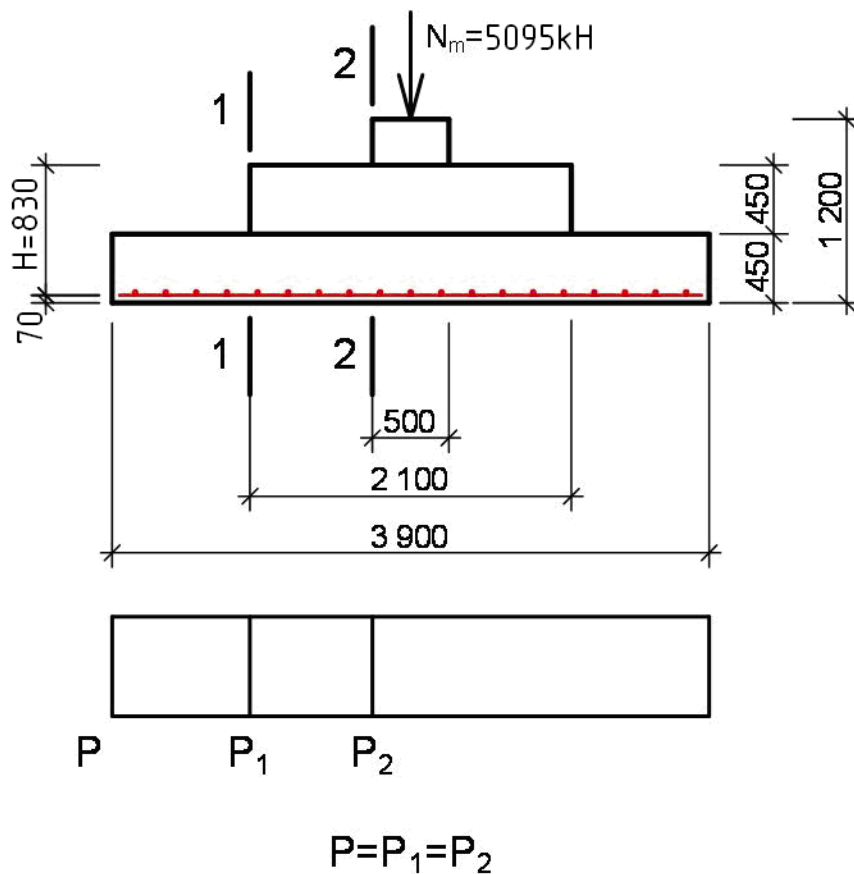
До визначення площі перерізу арматури підошви фундаменту
